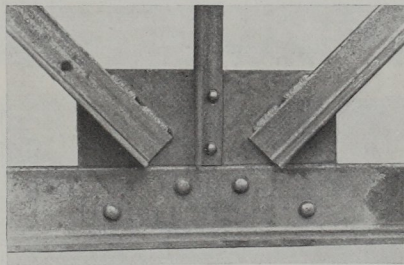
Knotenpunkt des halb genietetes, halb geschweißten Brückenträgers
